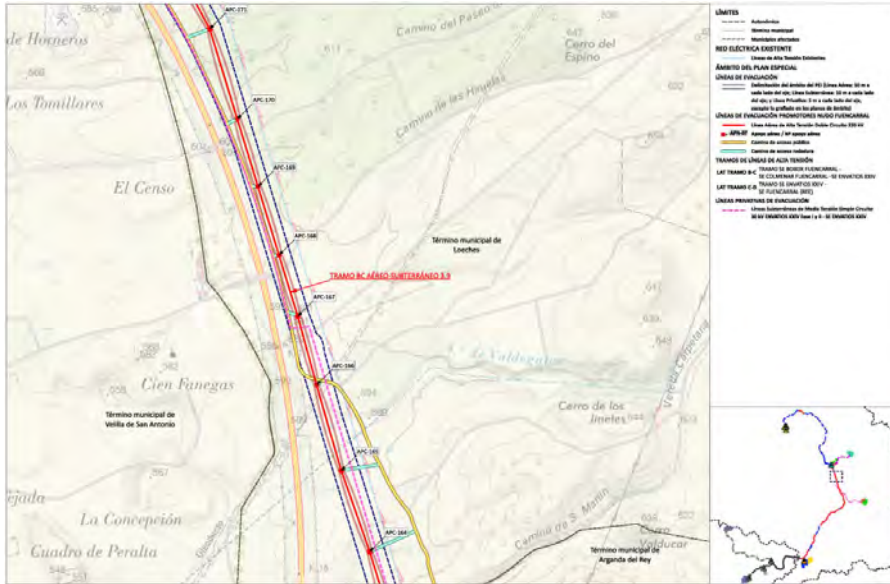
Plano de Ordenación O2.4.7. Planta por tramos. Instalaciones Envatios XXIV
